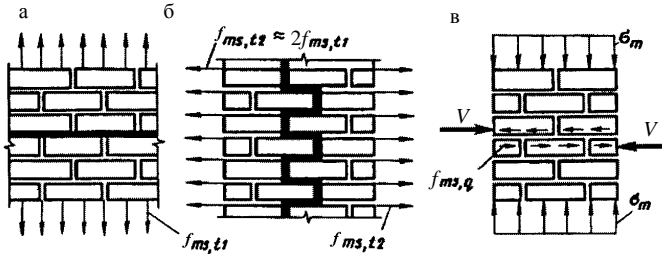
Схема руйнування кладки розтягу по неперев'язаному (а) і перев'язаному (б) перерізі, а також зрізу (в)
